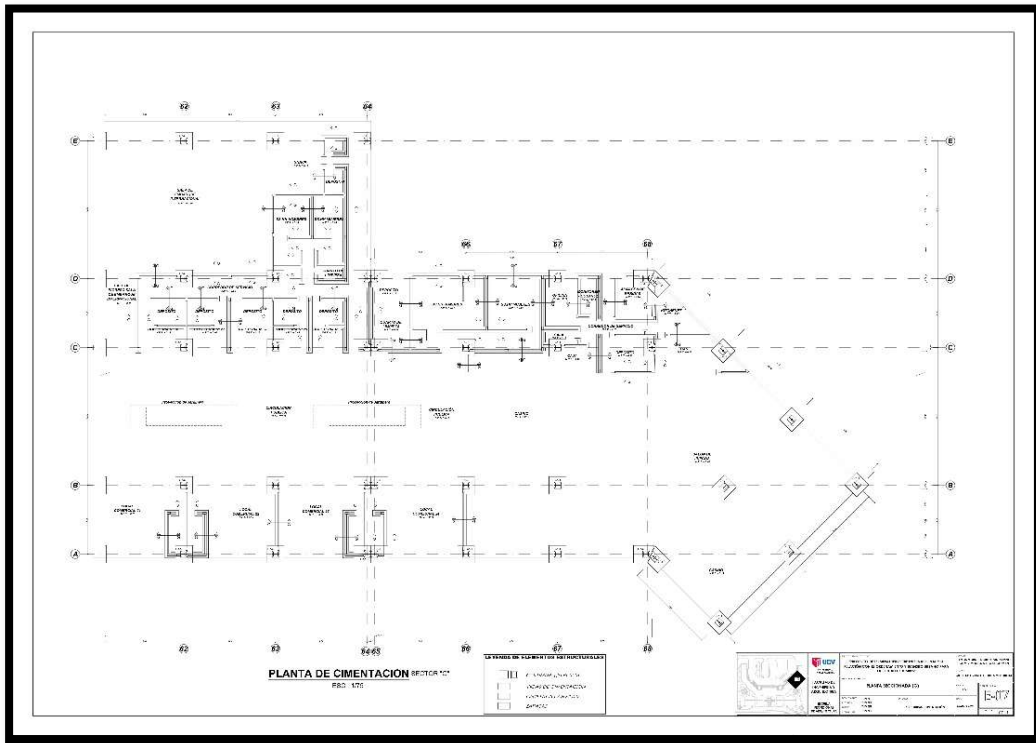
Plano de Cimentación Sector (G) Fuente: Elaboración Propia.
